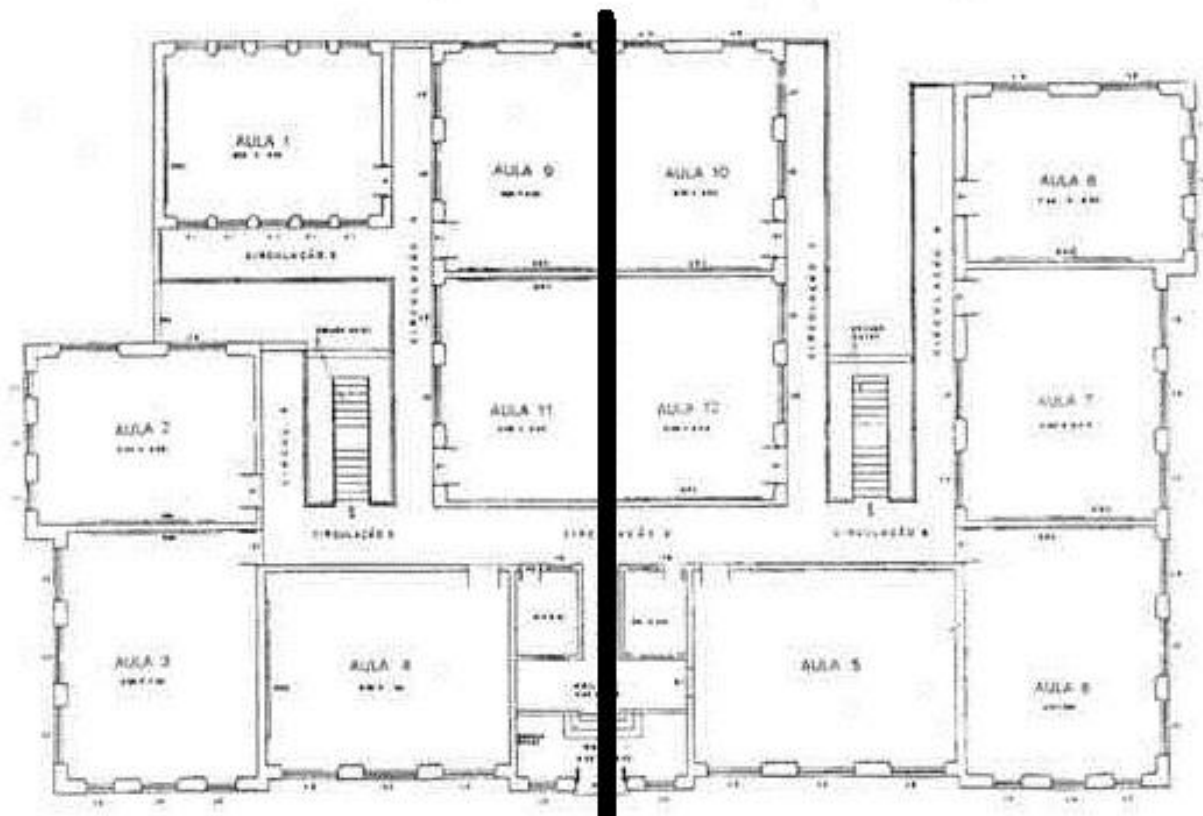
Planta baixa do pavimento superior do Grupo Escolar Olegário Maciel
